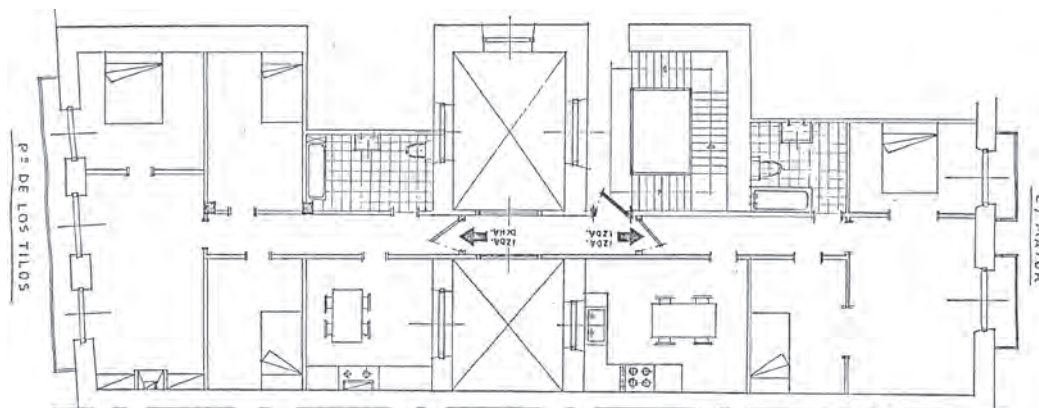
38. PLANO DEL ESTADO DE LA VIVIENDA 2º A EN 1984 TRAS LA REFORMA²⁸
